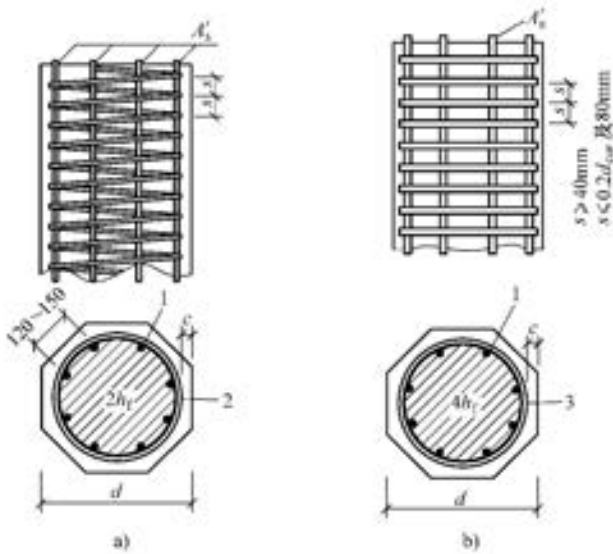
螺旋式和焊接环式箍筋柱
